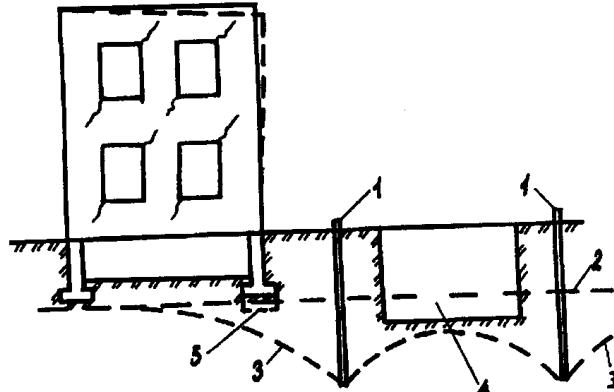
Схема деформации здания вследствие понижения уровня грунтовых вод:
